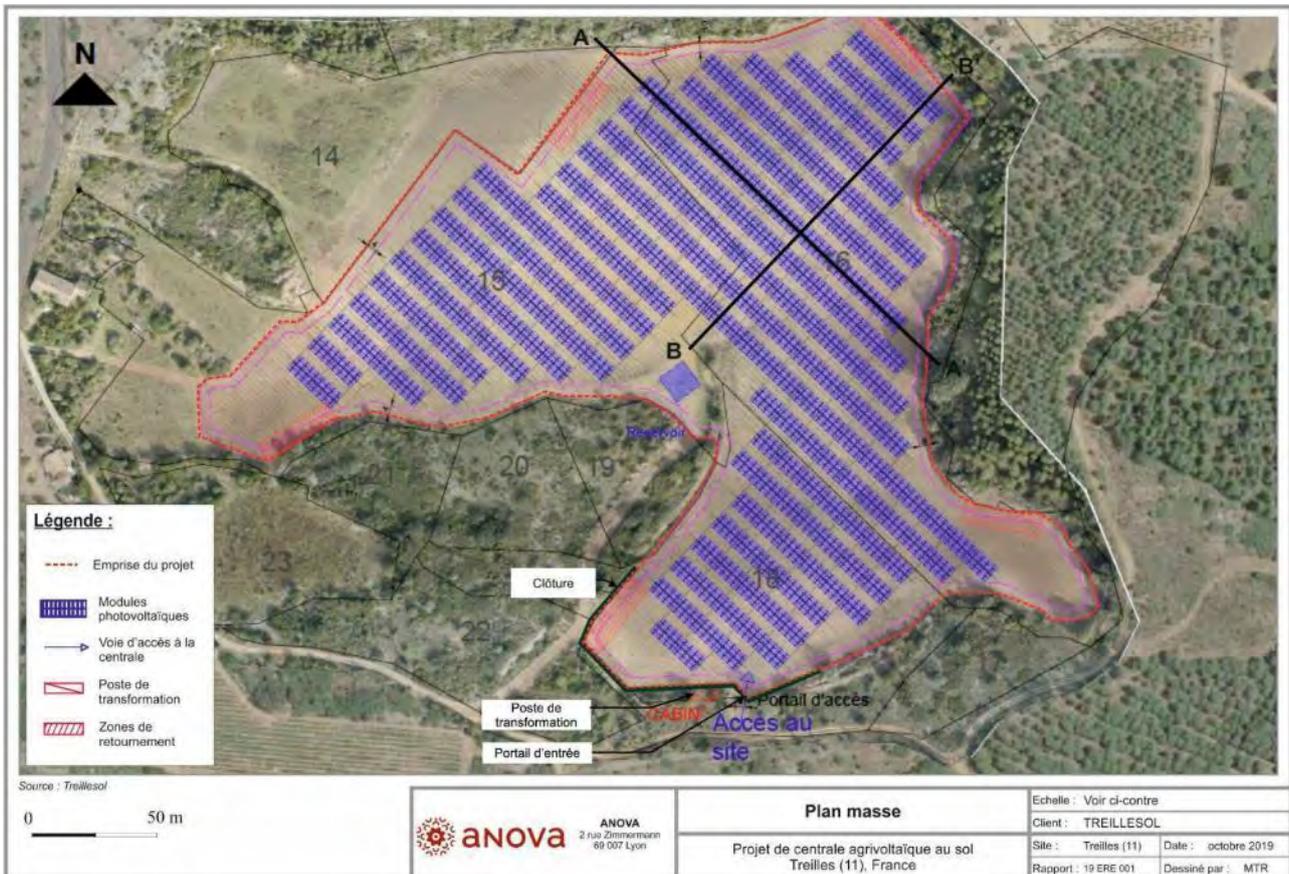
Plan masse du projet (Source : TREILLESOL, ANOVA 2020)
